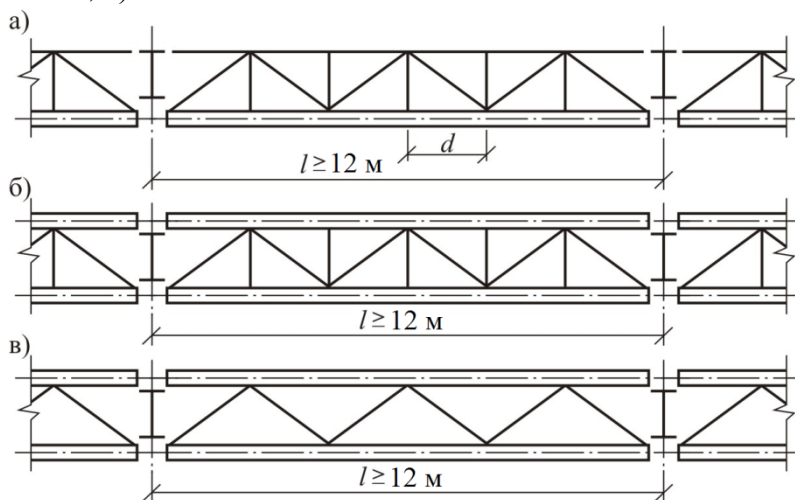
Схеми гальмівних і в'язевих ферм:
